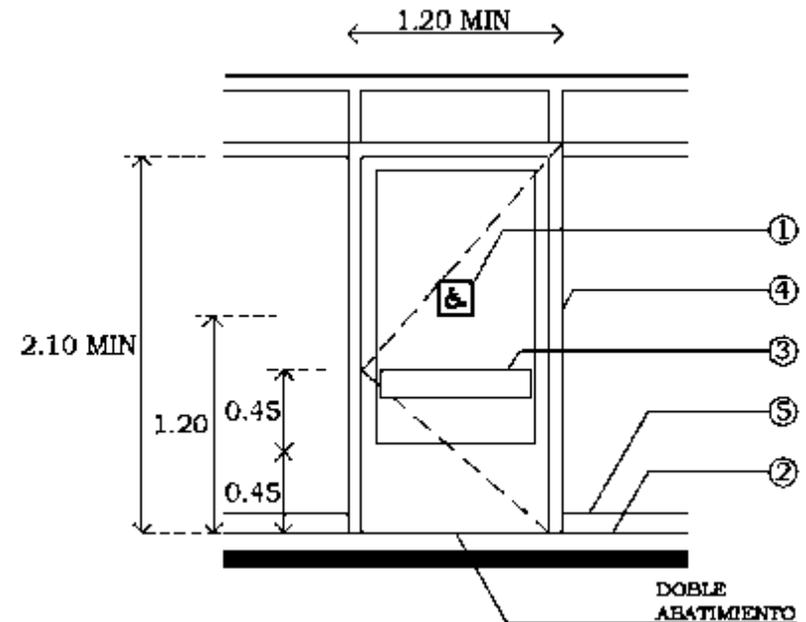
Detalles de Puerta Sencilla Vista Frontal
